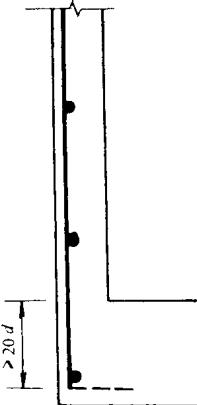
板上部受力钢筋焊接网与混凝土梁的连接
